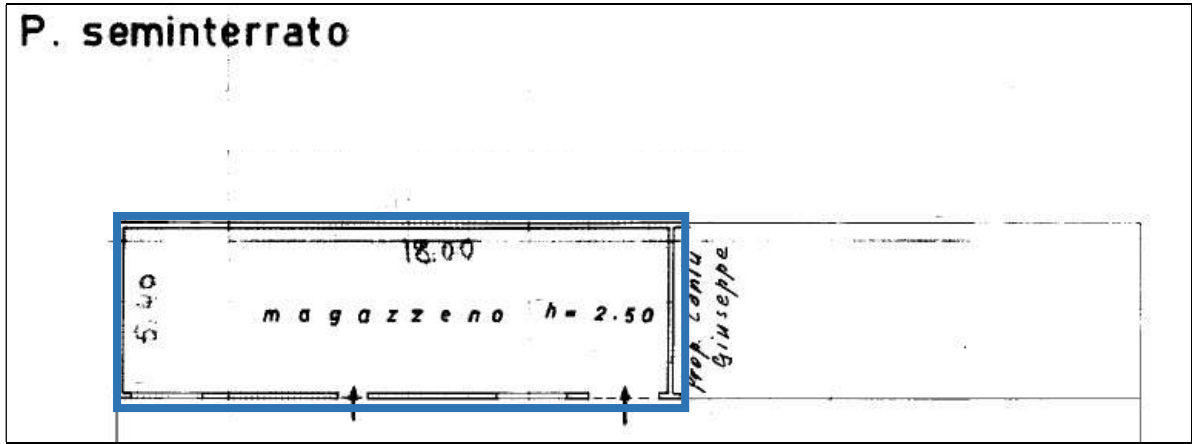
Estratto planimetria – Sez. SNA fg.6 Part. 4095 sub 3
